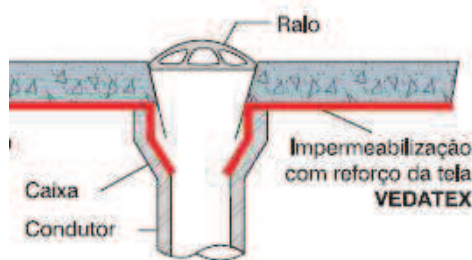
Detalhe da impermeabilização e grelha dos ralos
